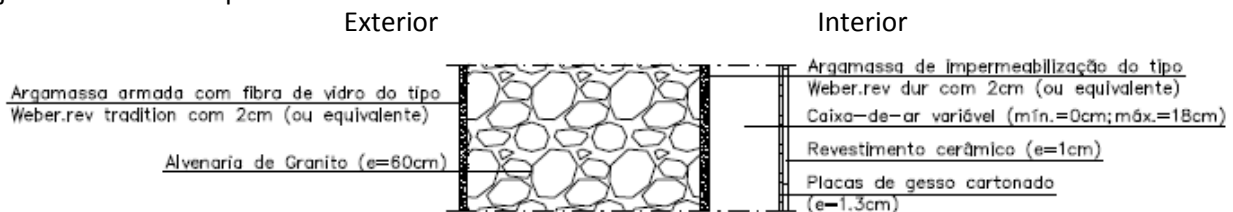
Pormenor construtivo da parede Pe6 [17]
